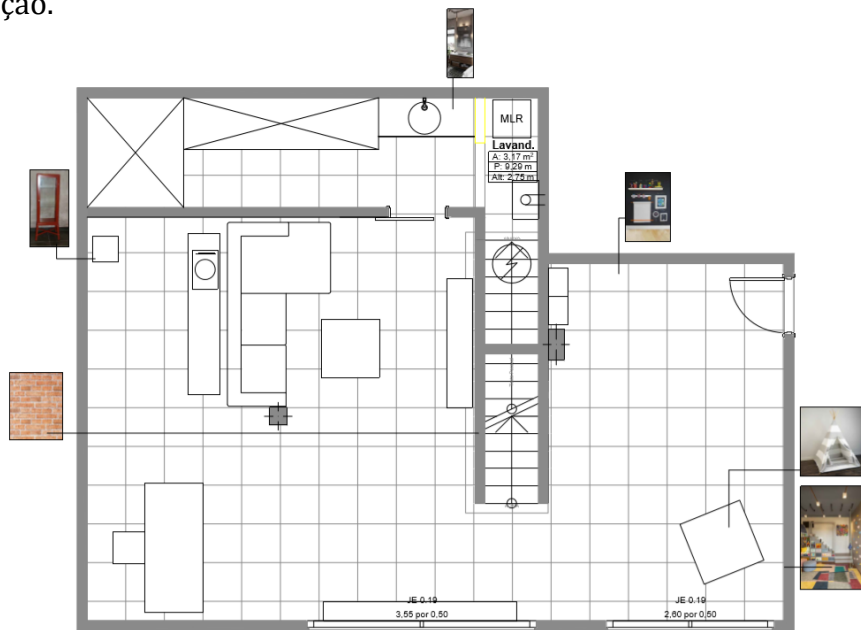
Planta de Apresentação Cave - Opção 01. Fonte: autor
